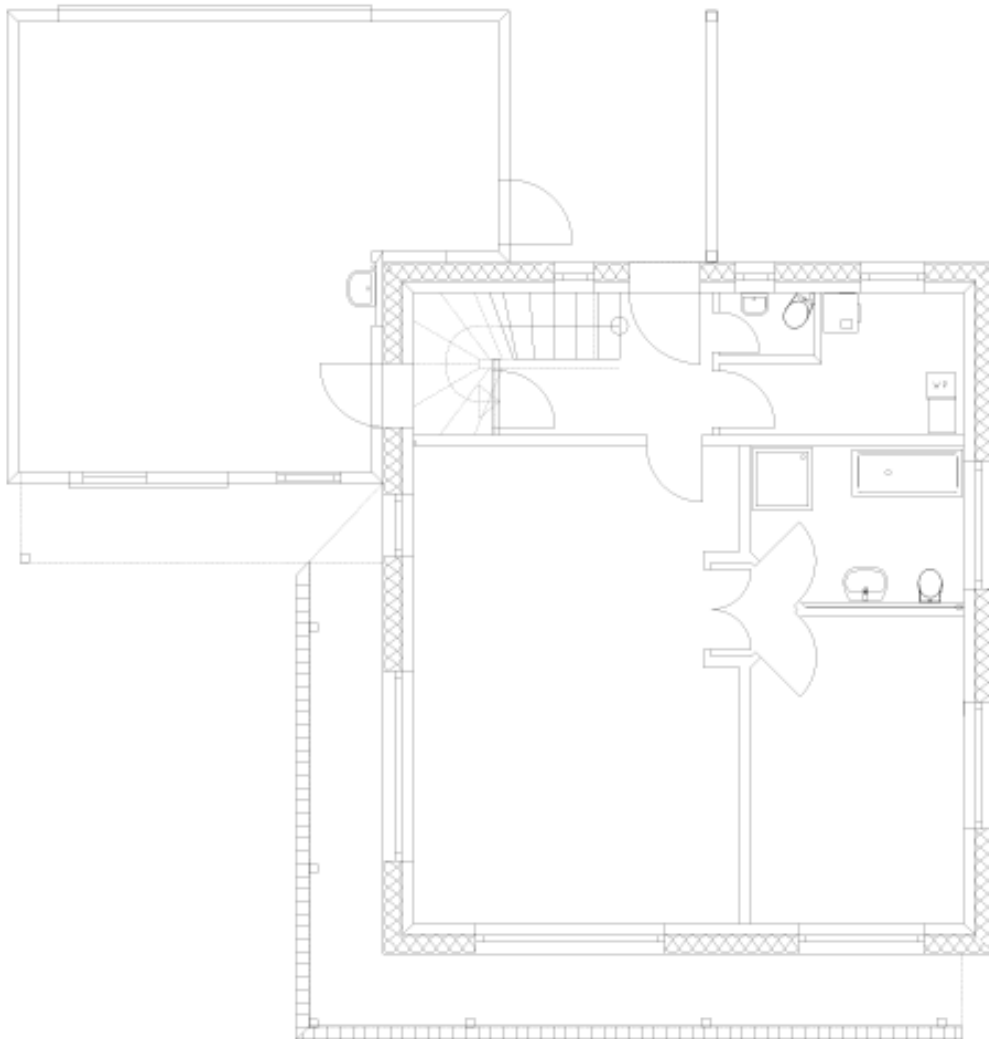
Grundriss EG mit Garage (Quelle: Architekturbüro Trykowski).
